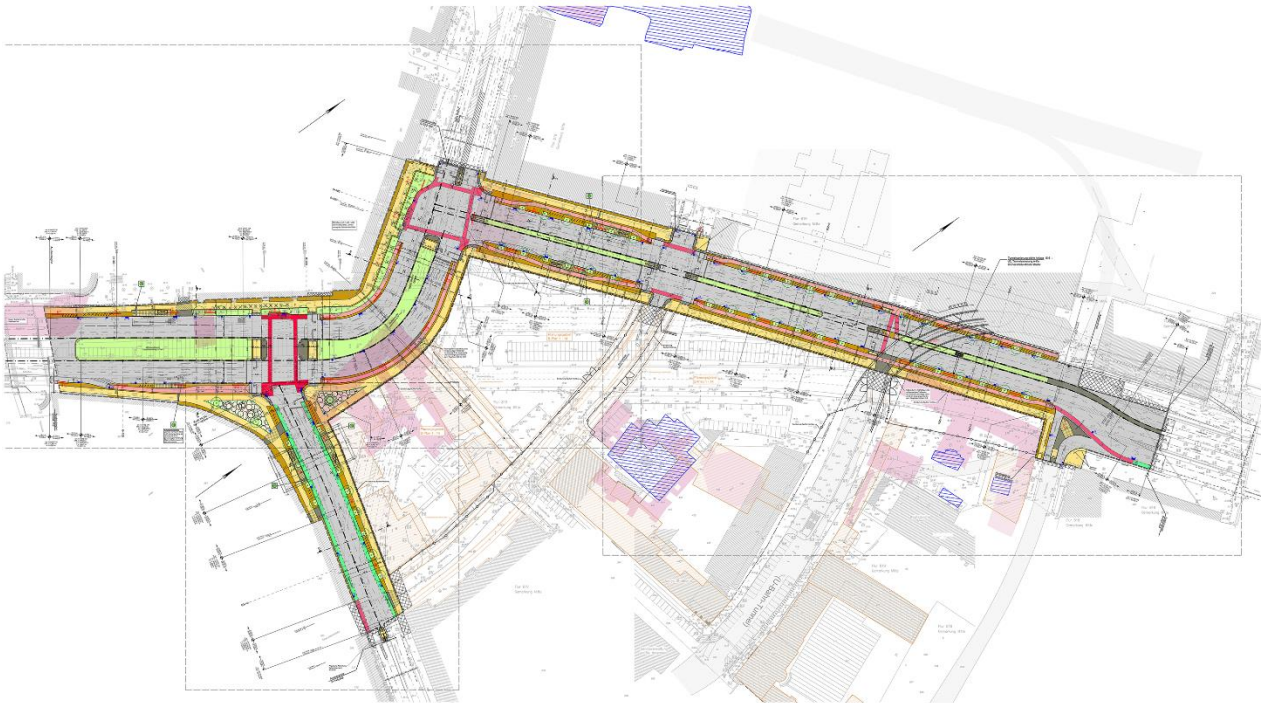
Planungen zur Neugestaltung/Verlegung der Grunerstraße, Molkenmarkt, Mühlendamm und Stralauer Straße, SenUVK
